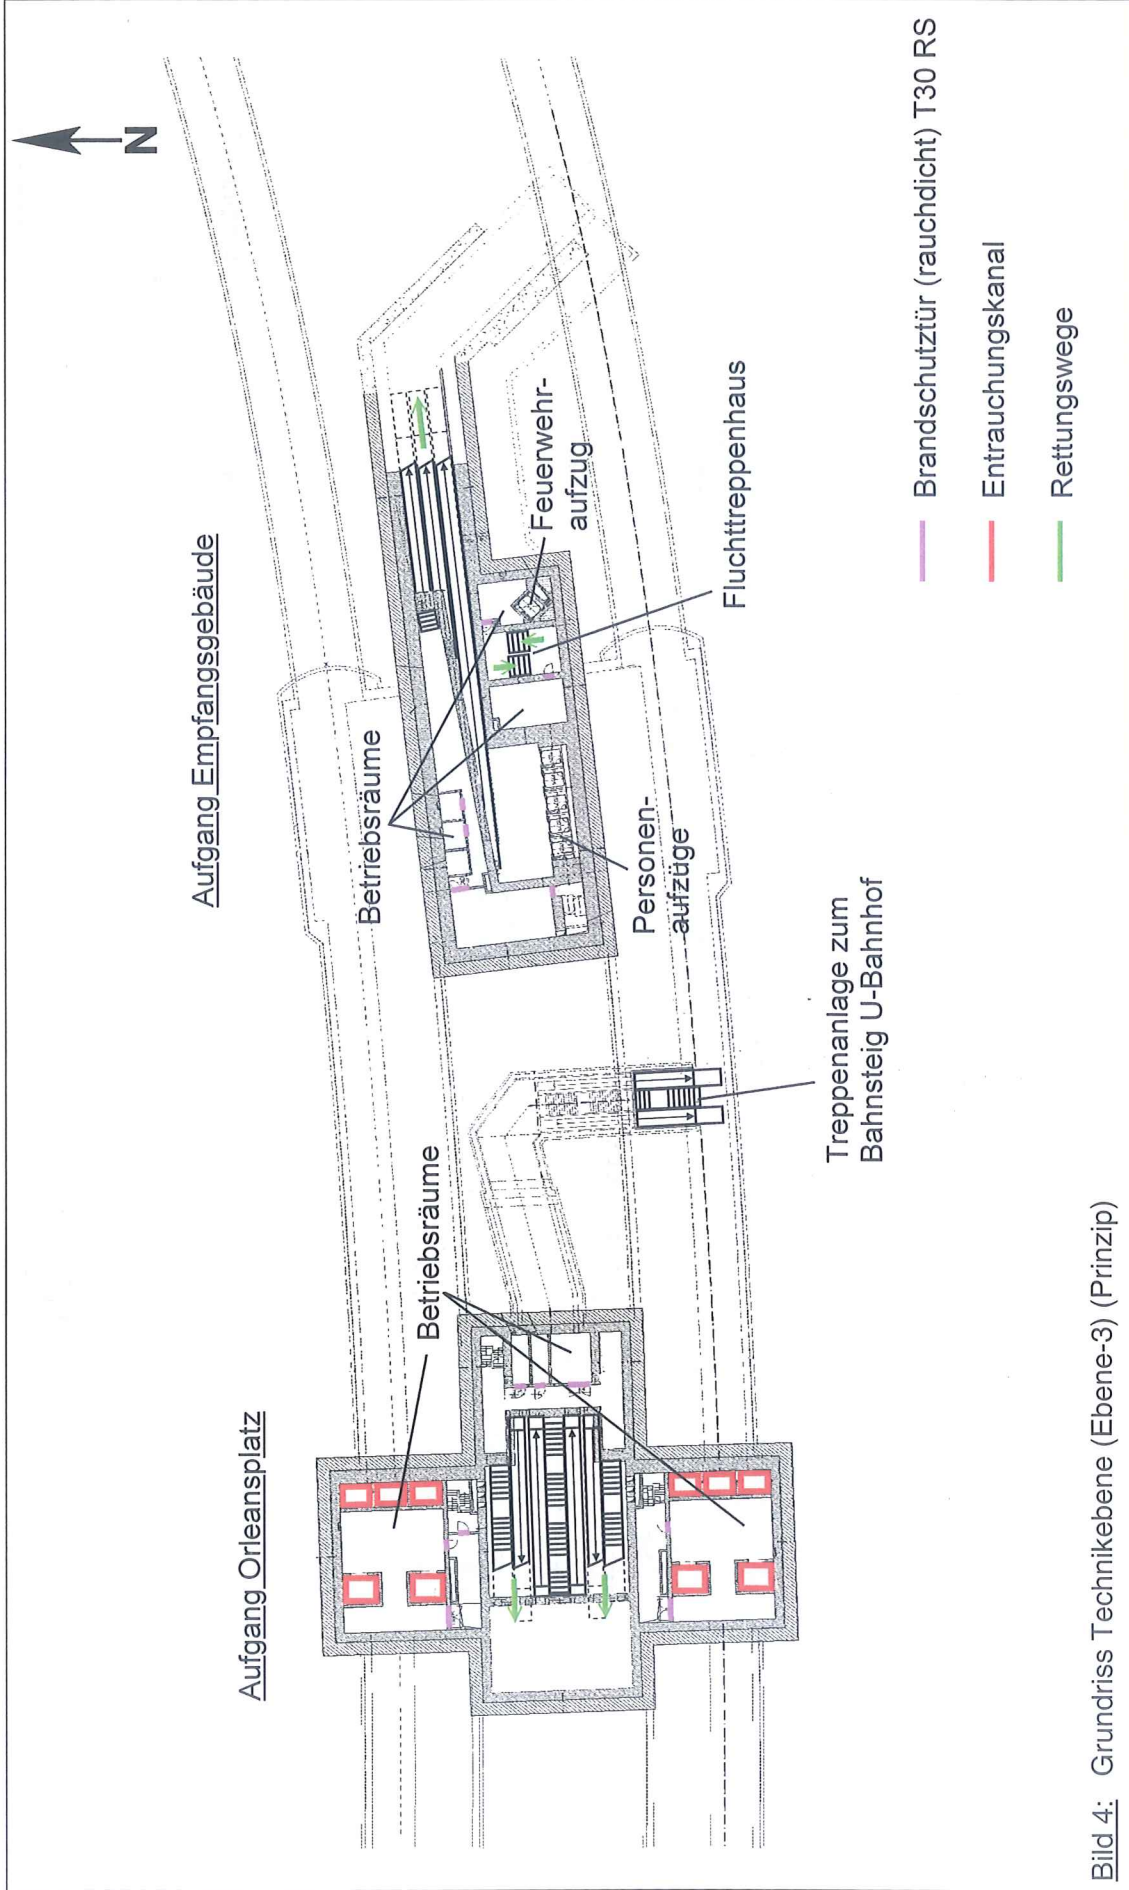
Grundriss Technikenebene (Ebene-3) (Prinzip)
